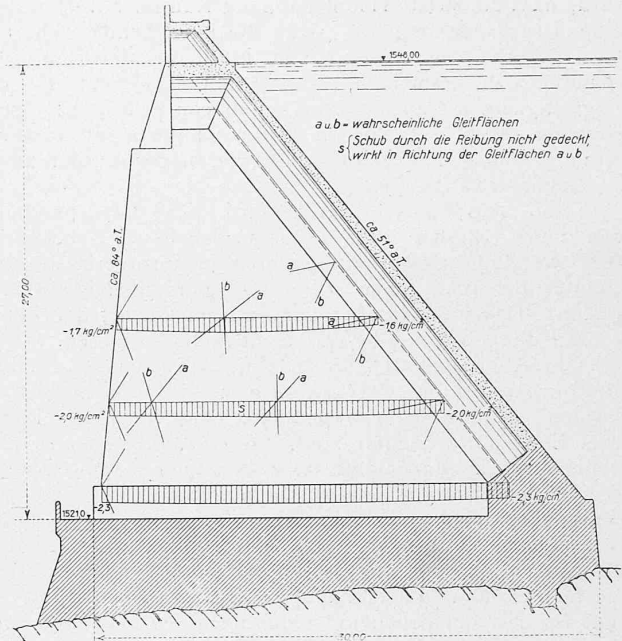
Schubbeanspruchung eines Pfeilers. (Mauermaassstab 1:400.)
